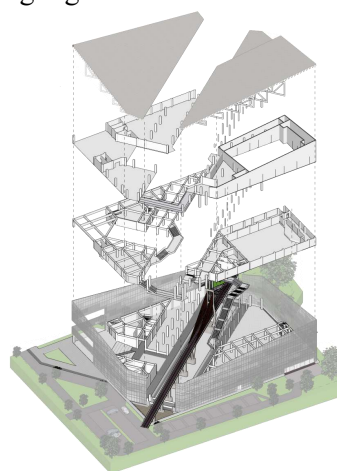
11. Keyplan Ruang Observasi Jembatan Suramadu
